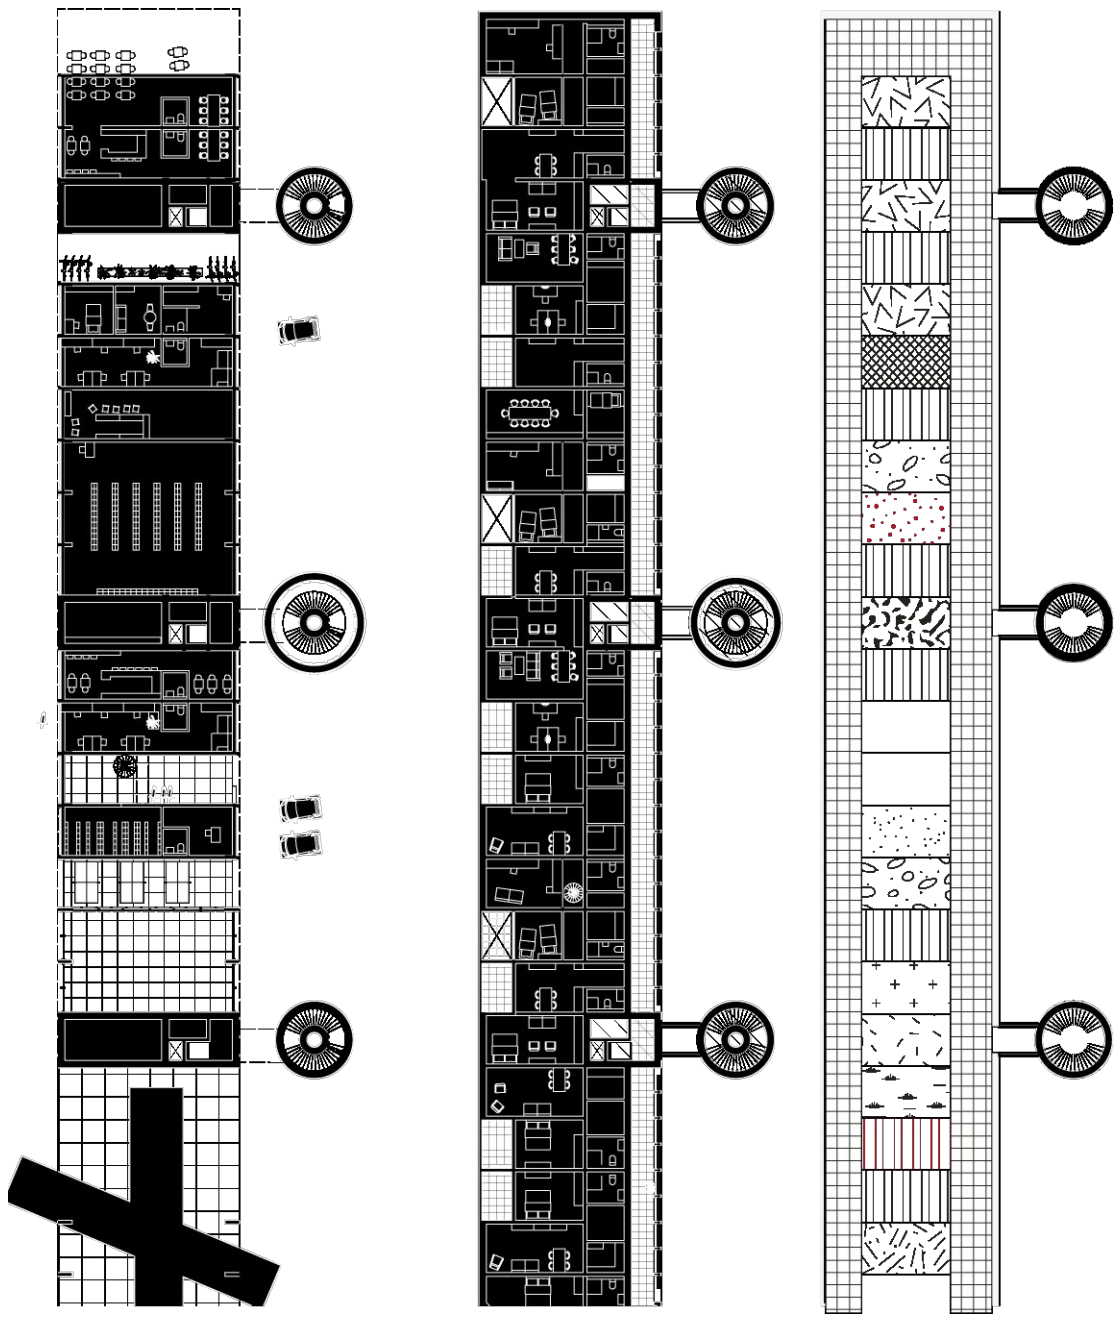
Grundrisse. Offenes Erdgeschoss, Typengrundriss und öffentliches Dachgeschoss
